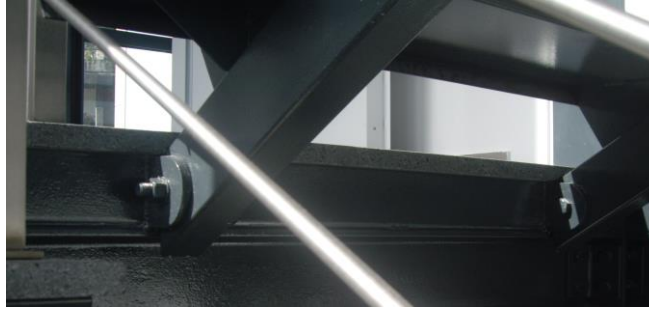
Pormenor da ligação entre a viga HEB180 e os perfis tubulares da escada
